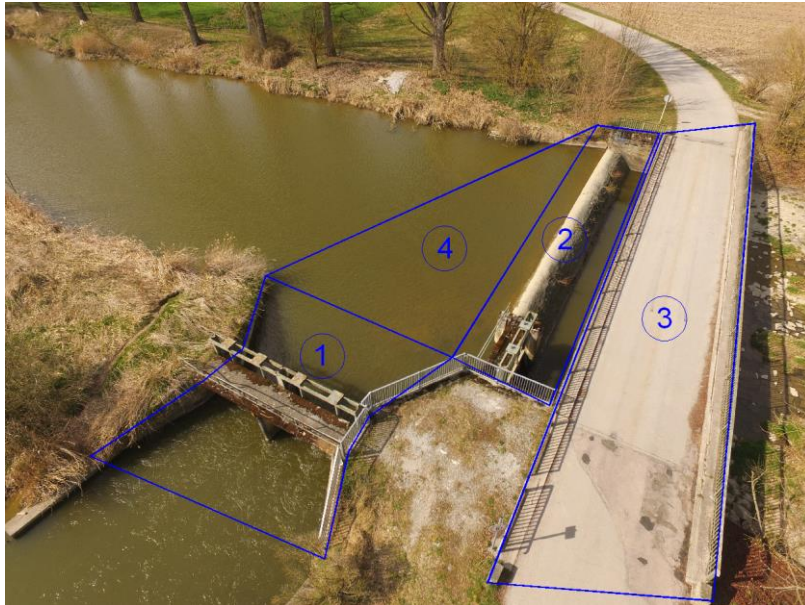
Bauwerksnummerierung (Quelle: Bau+Plan)
